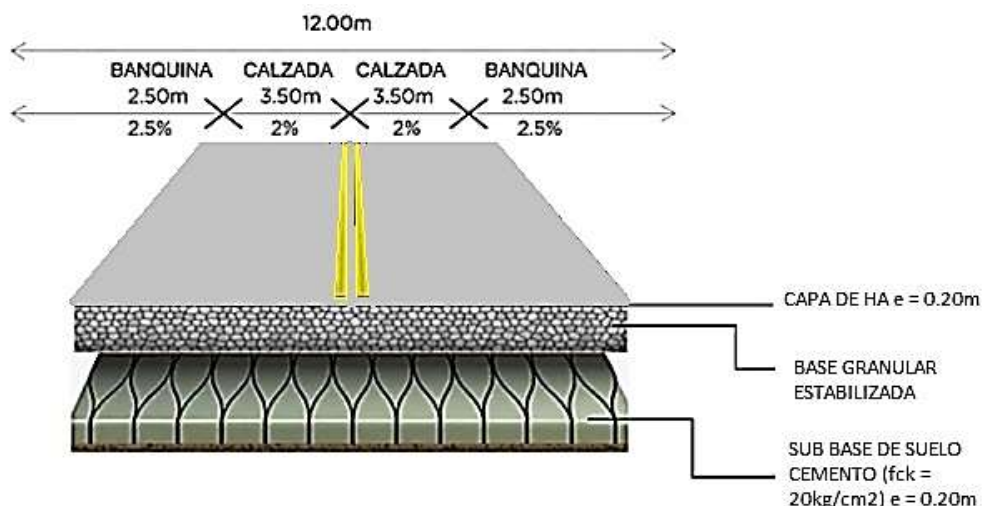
Paquete estructural de un pavimento rígido con materiales mejorados
